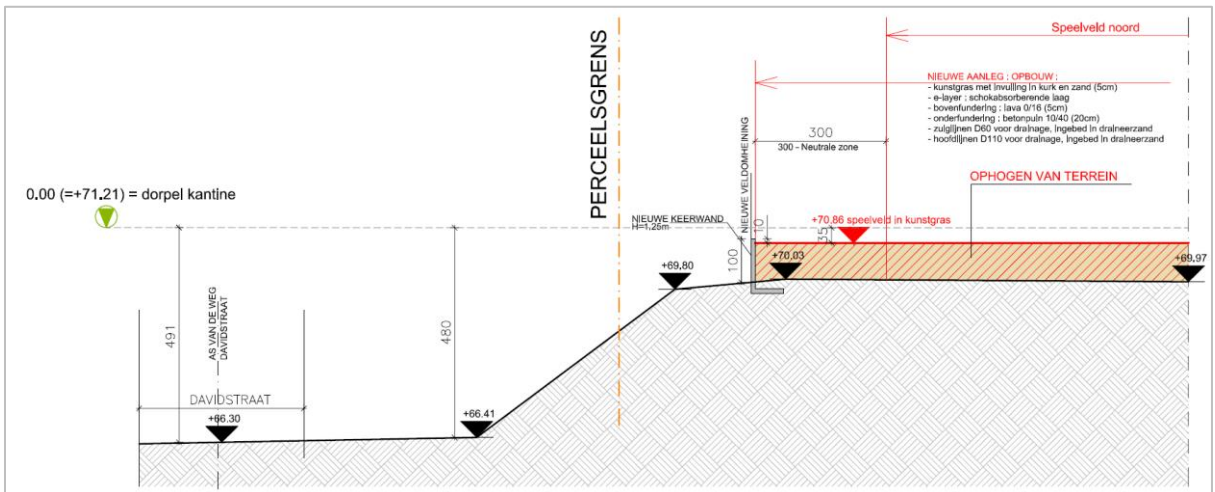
Plannen met de geplande werken (AE + architecten, 2018).
